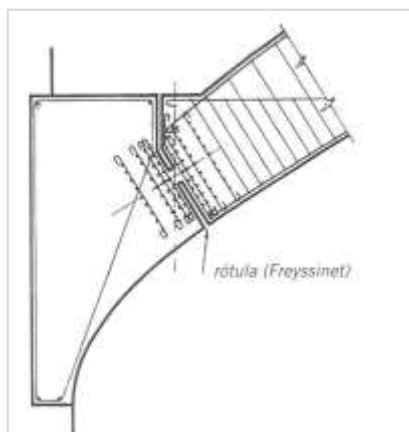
Rótula de Freyssinet en estructuras de puentes de hormigón armado. En: Eduardo Torroja, Razón y Ser de los Tipos Estructurales, Madrid, 2010, p. 71.
